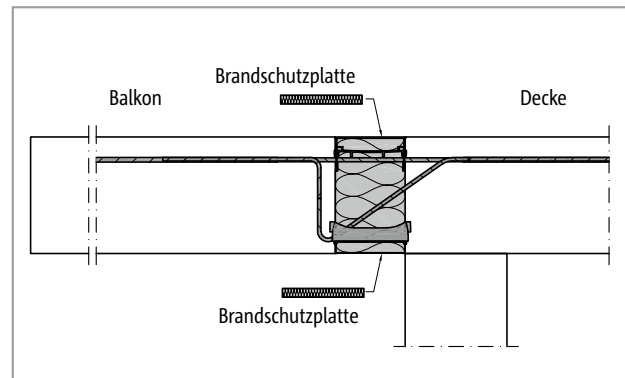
Schöck Isokorb® XT Typ K...-RO: Nachträgliche Sanierung mit Brandschutzplatten
